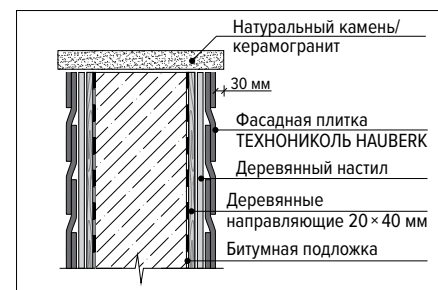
Монтаж фасадной плитки на подпорную стенку. Вариант 1
